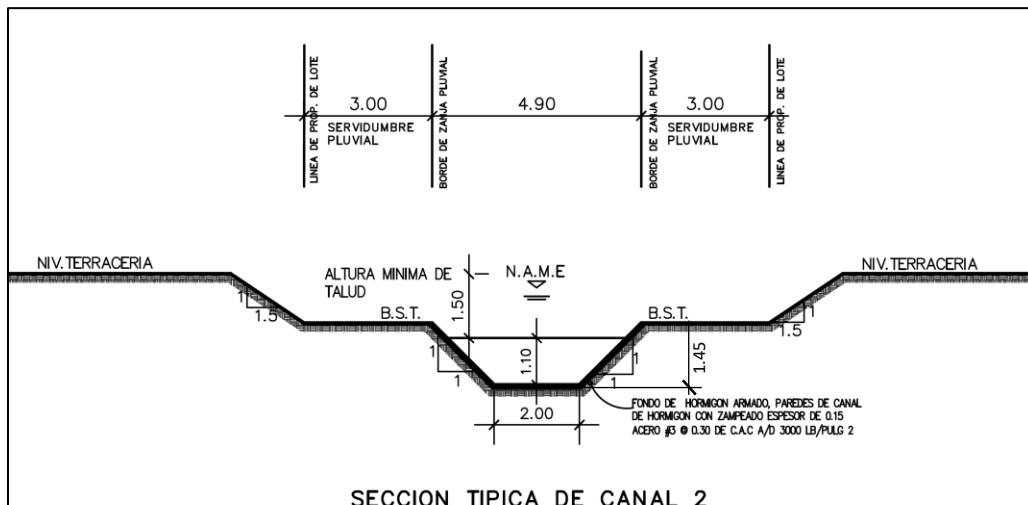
Secciones transversales óptimas conformadas en concreto, propuesta para el drenaje pluvial "Sin Nombre 2"
